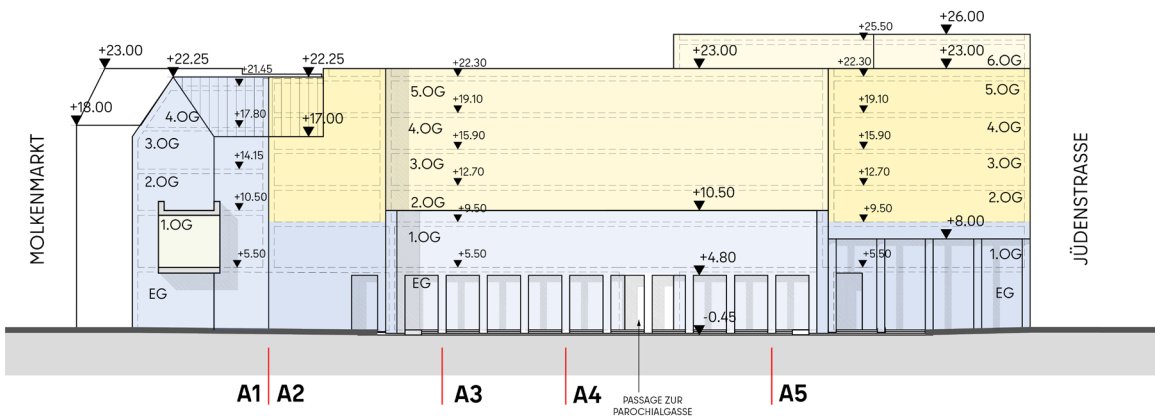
Schematische Ansicht Stadtplatz-Nord (Wohnbebauung)
